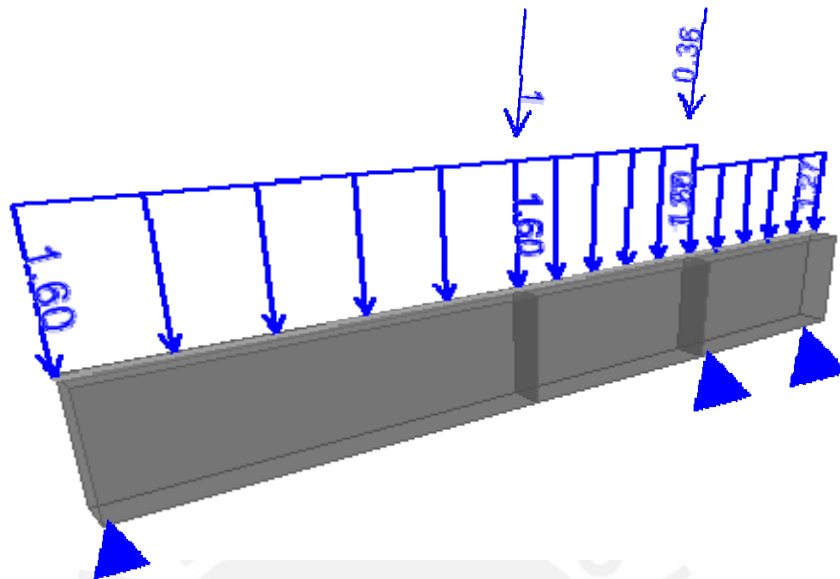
Cargas muertas y cargas puntuales en viga ( Ton x m ) y ( Ton)
